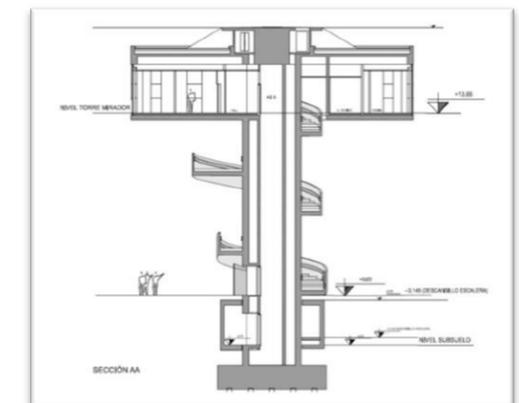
Y 44: CORTES ARQUITECTÓNICOS DEL EDIFICIO
